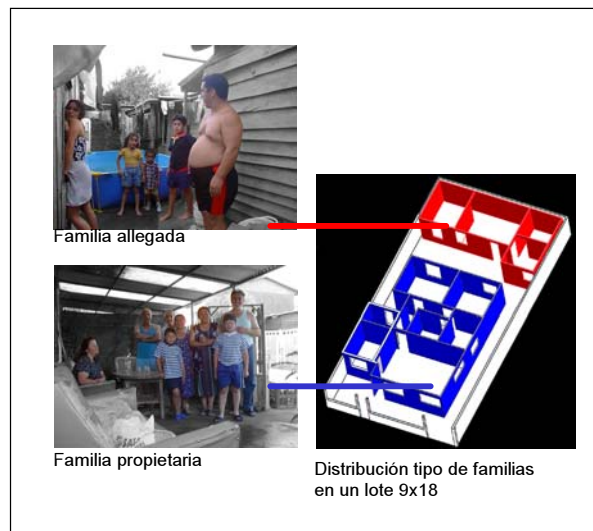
Distribución familias allegadas y propietarias en lotes 9x18.
